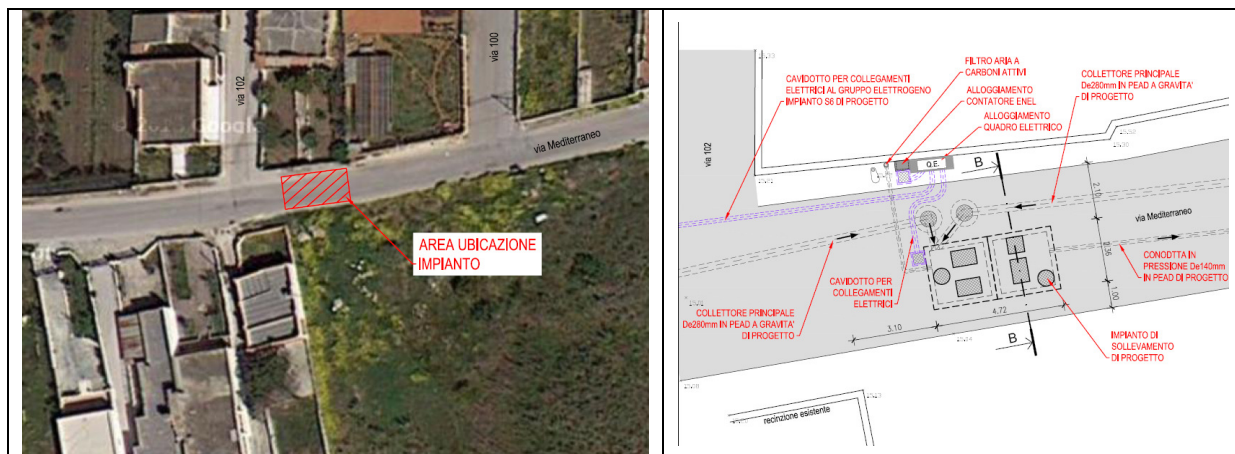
Localizzazione territoriale dell'impianto e planimetria con le sistemazioni previste.
